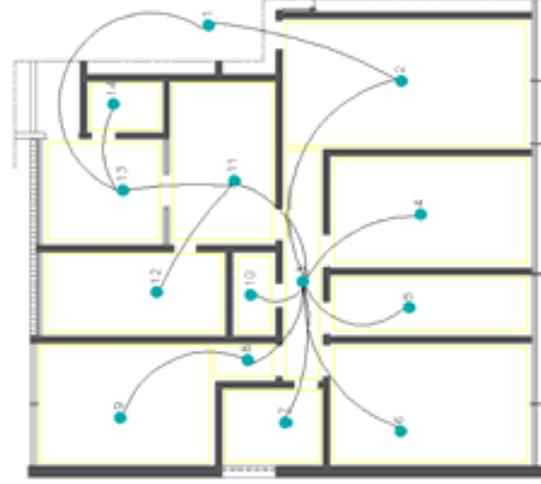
SQS 303 – Bloco C – Asa Sul - Planta Modificada
